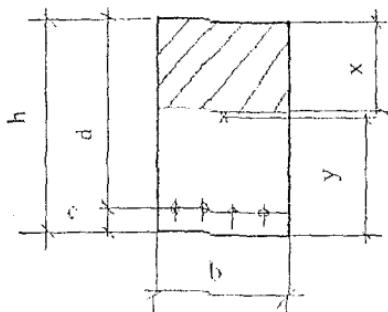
К расчету геометрических характеристик приведенного прямоугольного сечения
